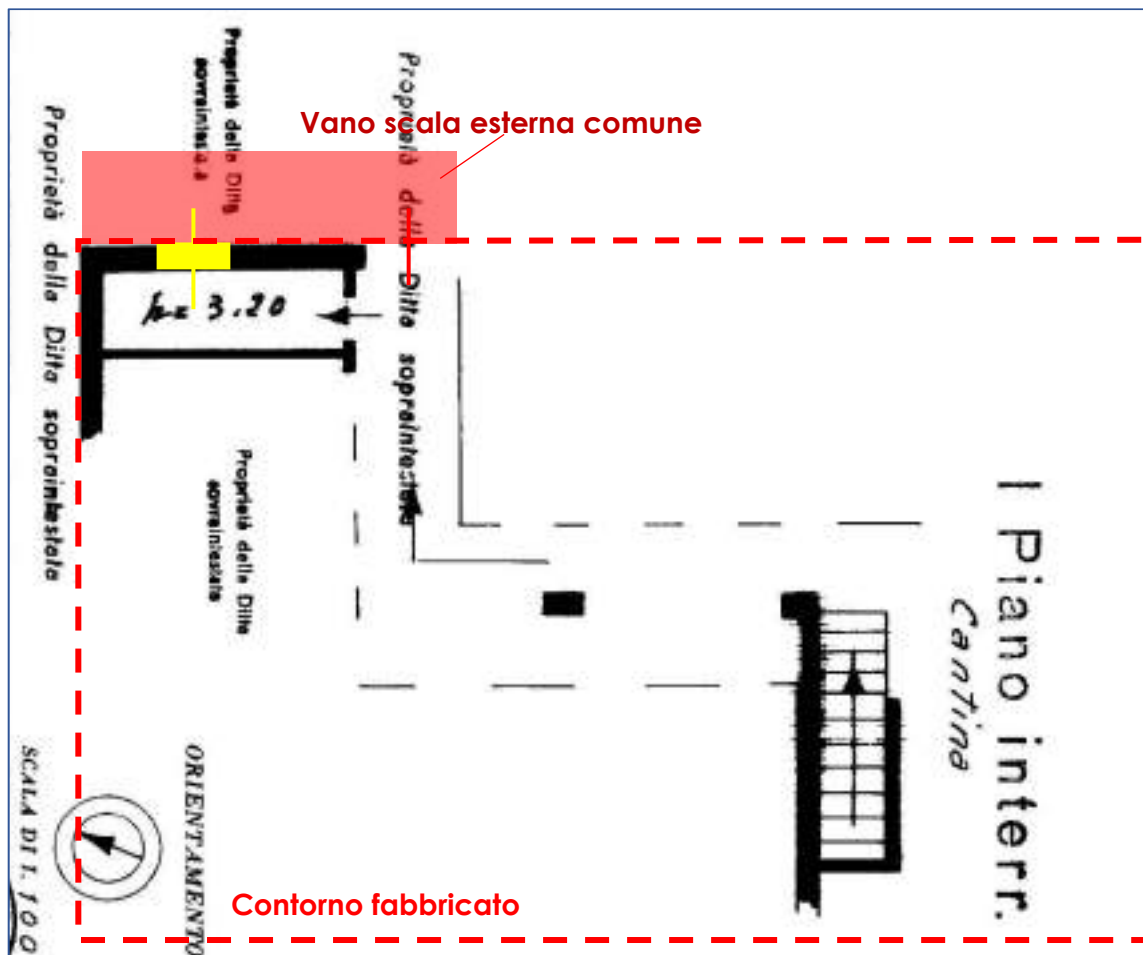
Estratto planimetria catastale (cantina) con l'individuazione del vano scala comune esterno e (in giallo) l'ingombro della finestra rilevata
